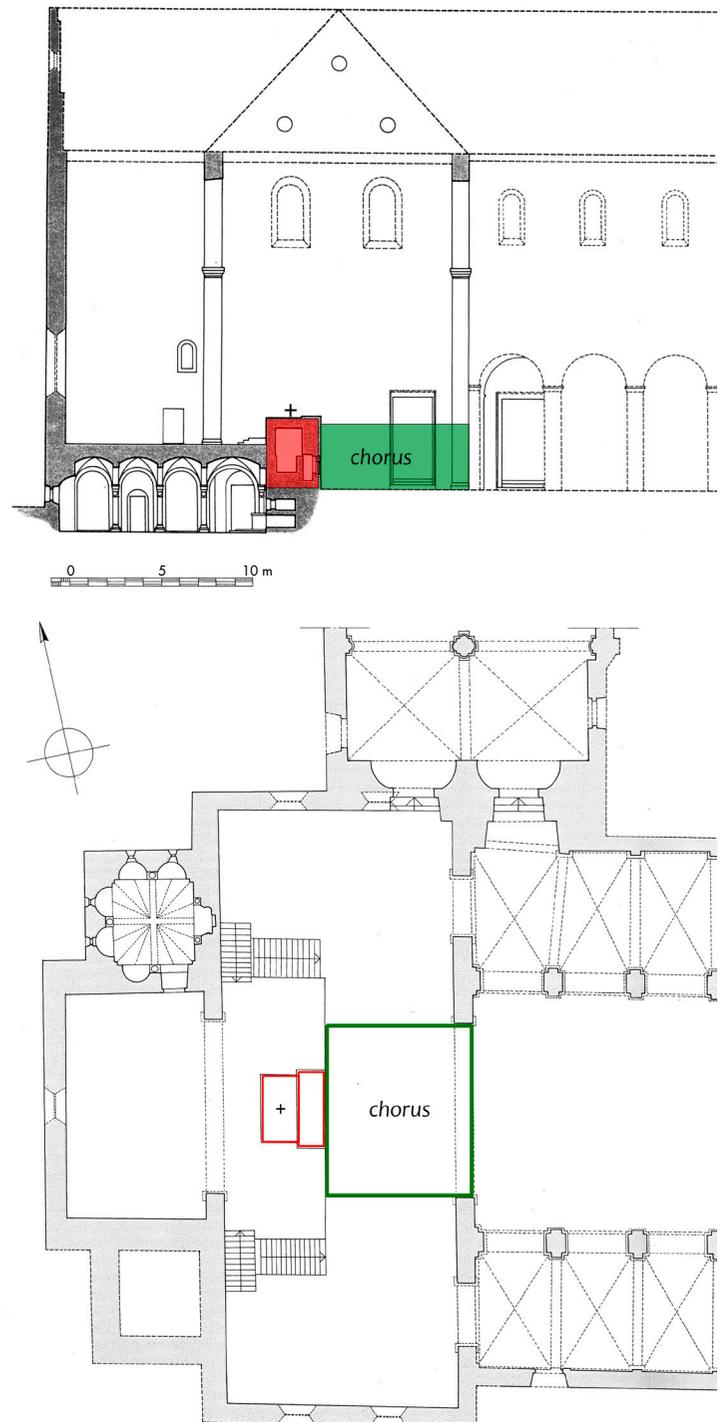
Regensburg, St. Emmeram. Schnitt durch den Westteil und Grundriss, Mitte 11. Jahrhundert; westlicher Hauptaltar und Chorstandort farbig markiert.
